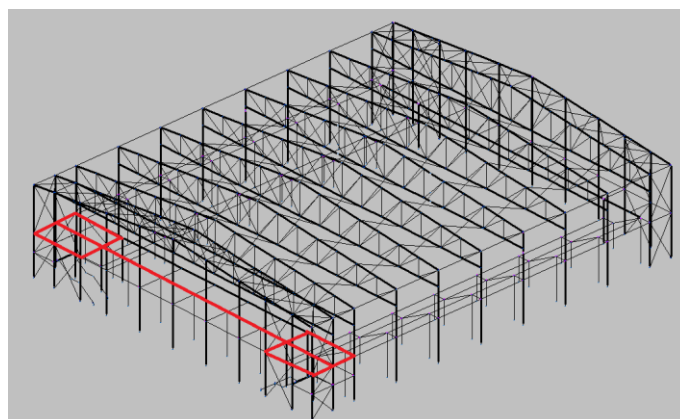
Vigas de la zona puente con aros de la segunda planta.
